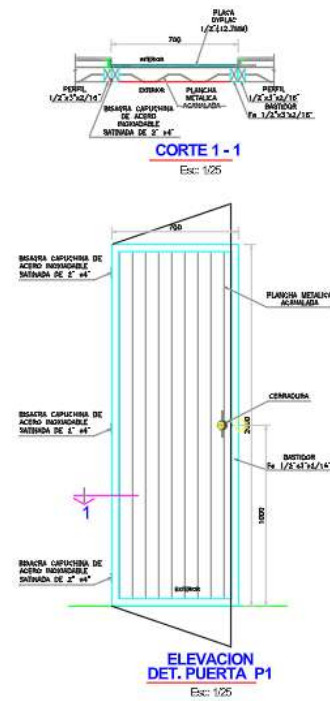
, Detalle #1 Puerta según prototipo, 2025 II, Wilson Lozano
